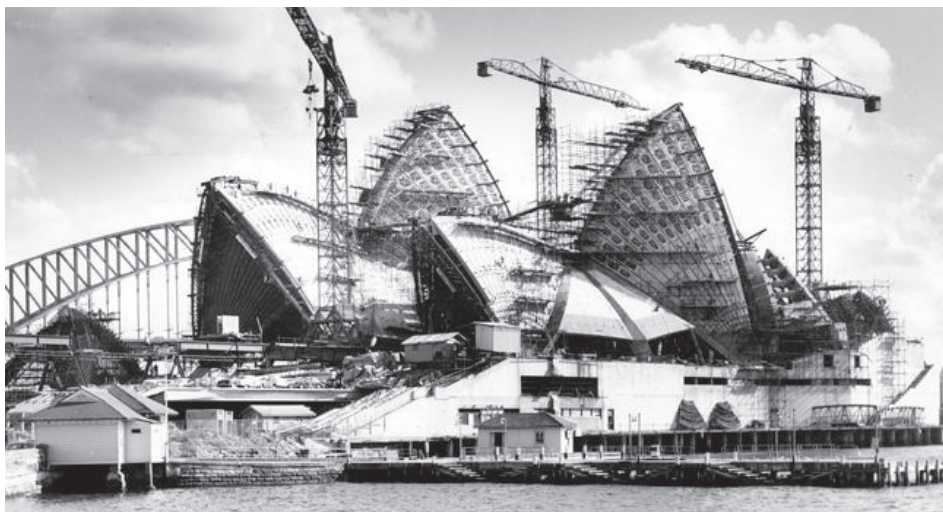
y 3-3-19: Secuencia de construcción de proyectos de pieles estructurales en sistemas semi-prefabricados colaborantes implementado en el proyecto Sydney Opera House (Utzon, 1957-73).
